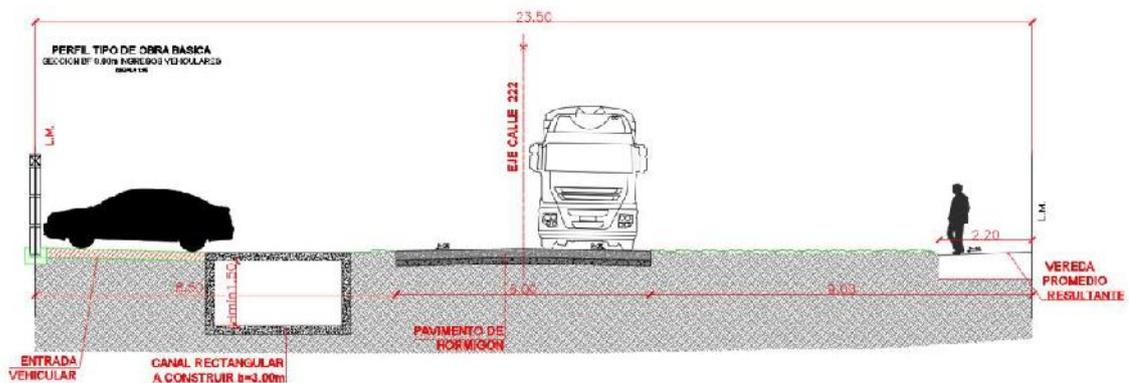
Perfil Tipo de Obra Básica. Canal Rectangular Cerrado. Ancho = 3.00m
